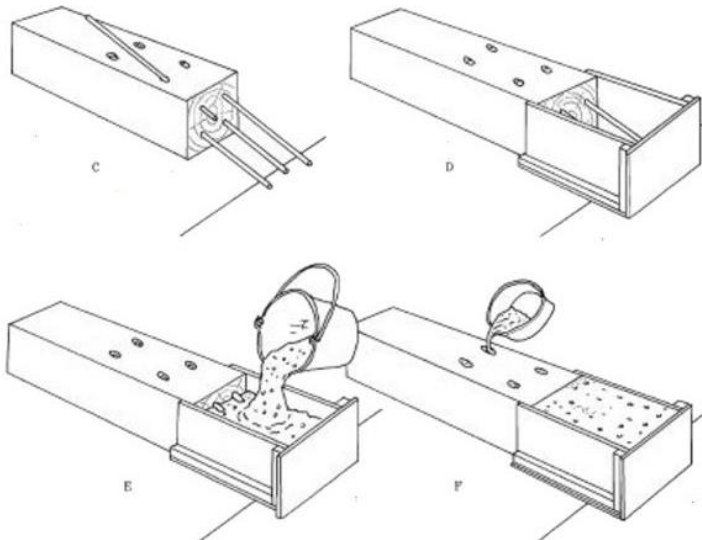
Detalle del empresillado de los pilares. 2023. Fuente: propia.
